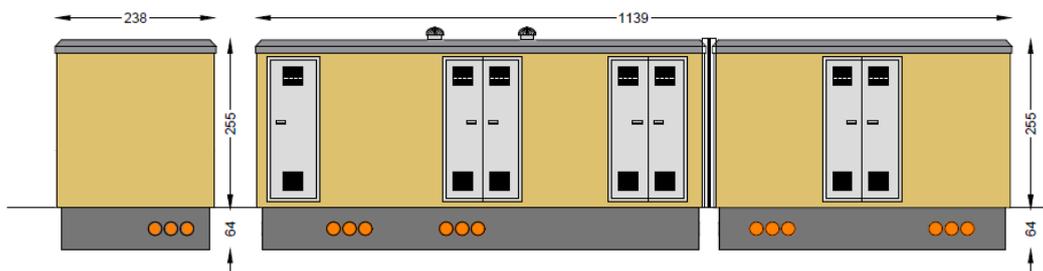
Prospetto della cabina MTR secondaria, misure in cm
